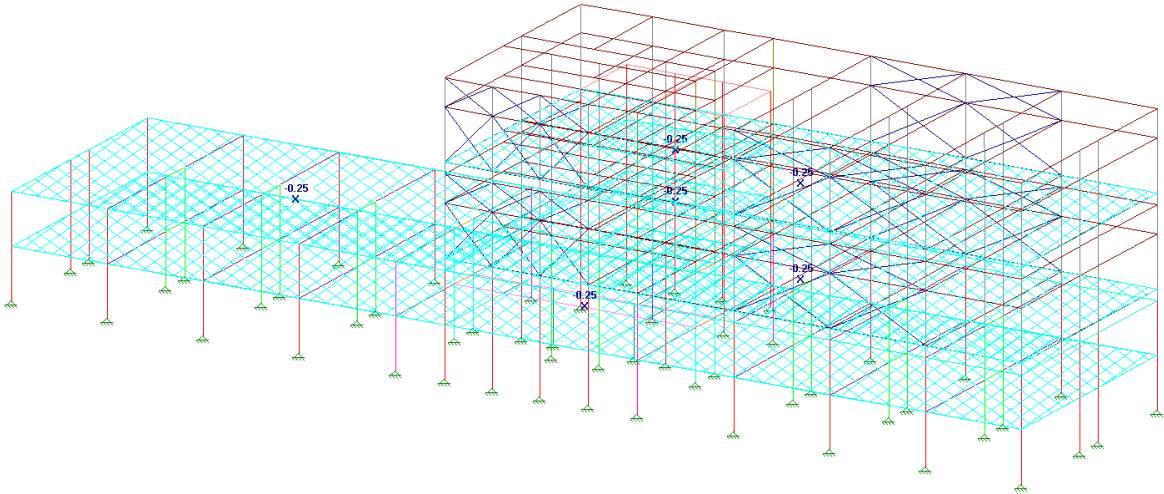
Carregamento da carga de utilização com um pavimento extra
